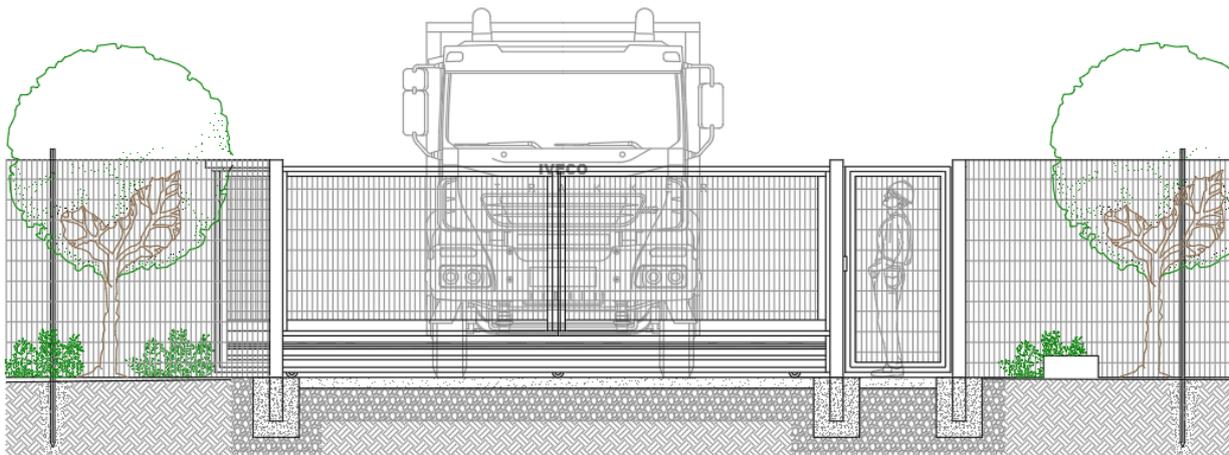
Particolari Recinzioni, Cancelli e Piantumazione Perimetrale
